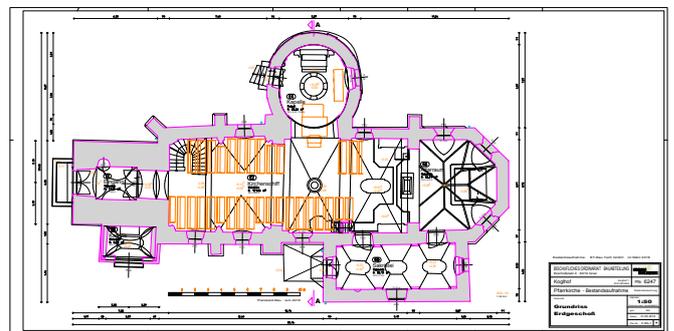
Pfarrkirche Koglhof – Grundrissplan - EG
